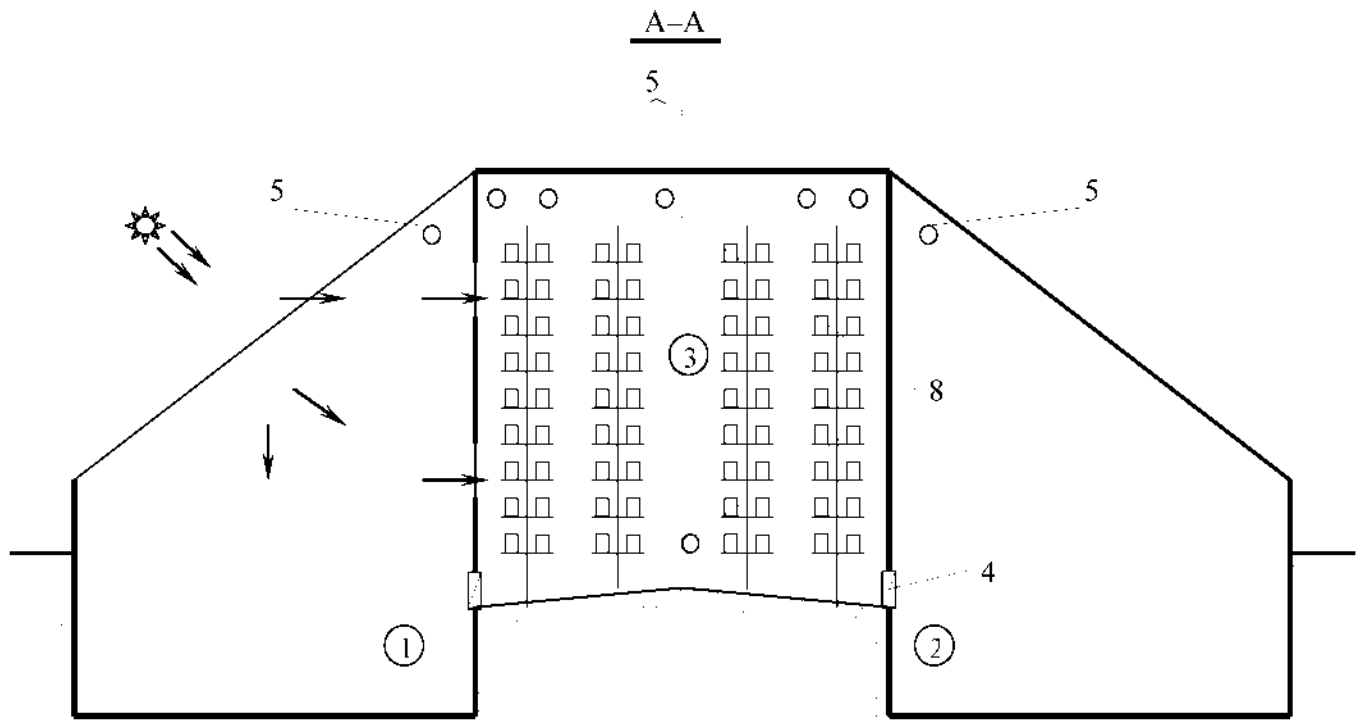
б. План-схема замкнутої системи вентиляції
